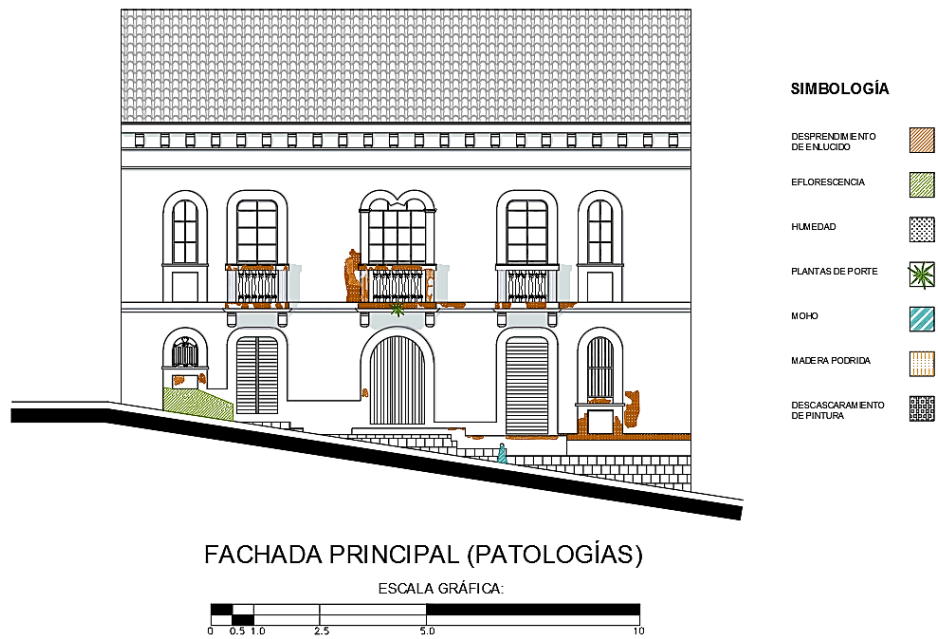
Patologías Fachada • *Fuente: Ilustración Propia
